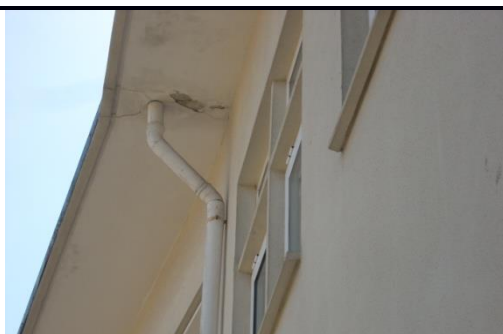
Destacamento, fissuras, saponificação e sujidade na fachada O.
